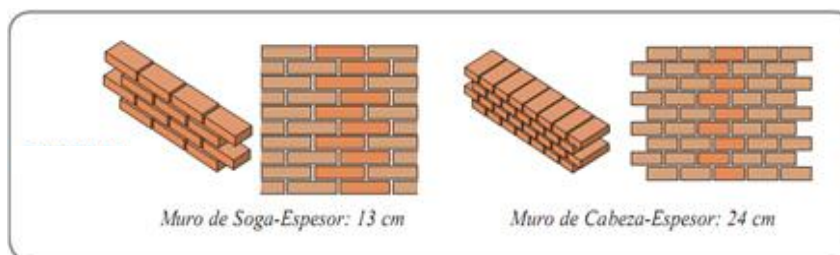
Tipo de aparejo: muro soga y muro de cabeza
